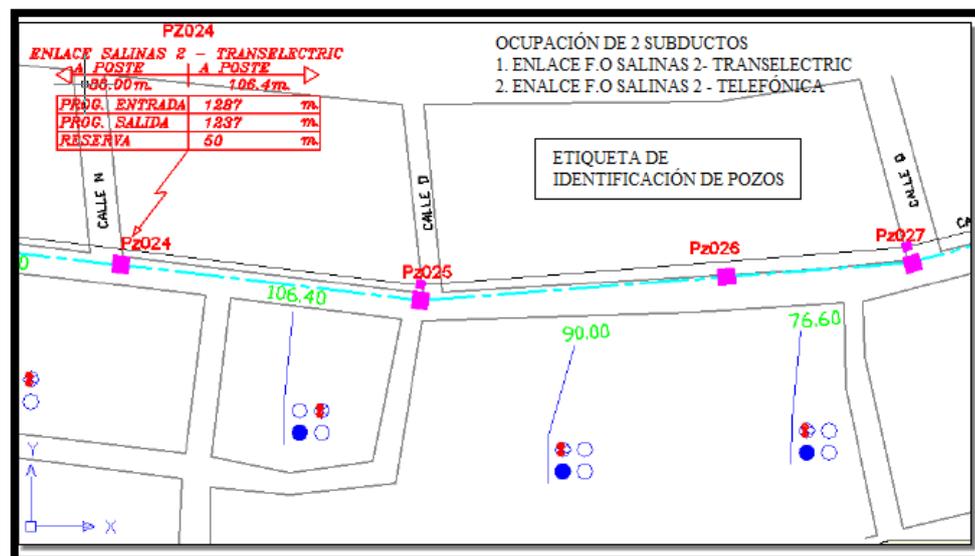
Ejemplo de planimetría para el tendido canalizado de Fibra Óptica
